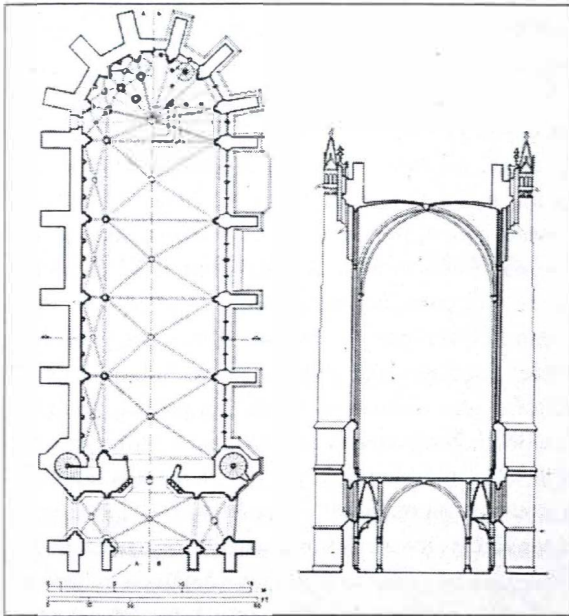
Sección y planta de la Sainte Chapelle. París
